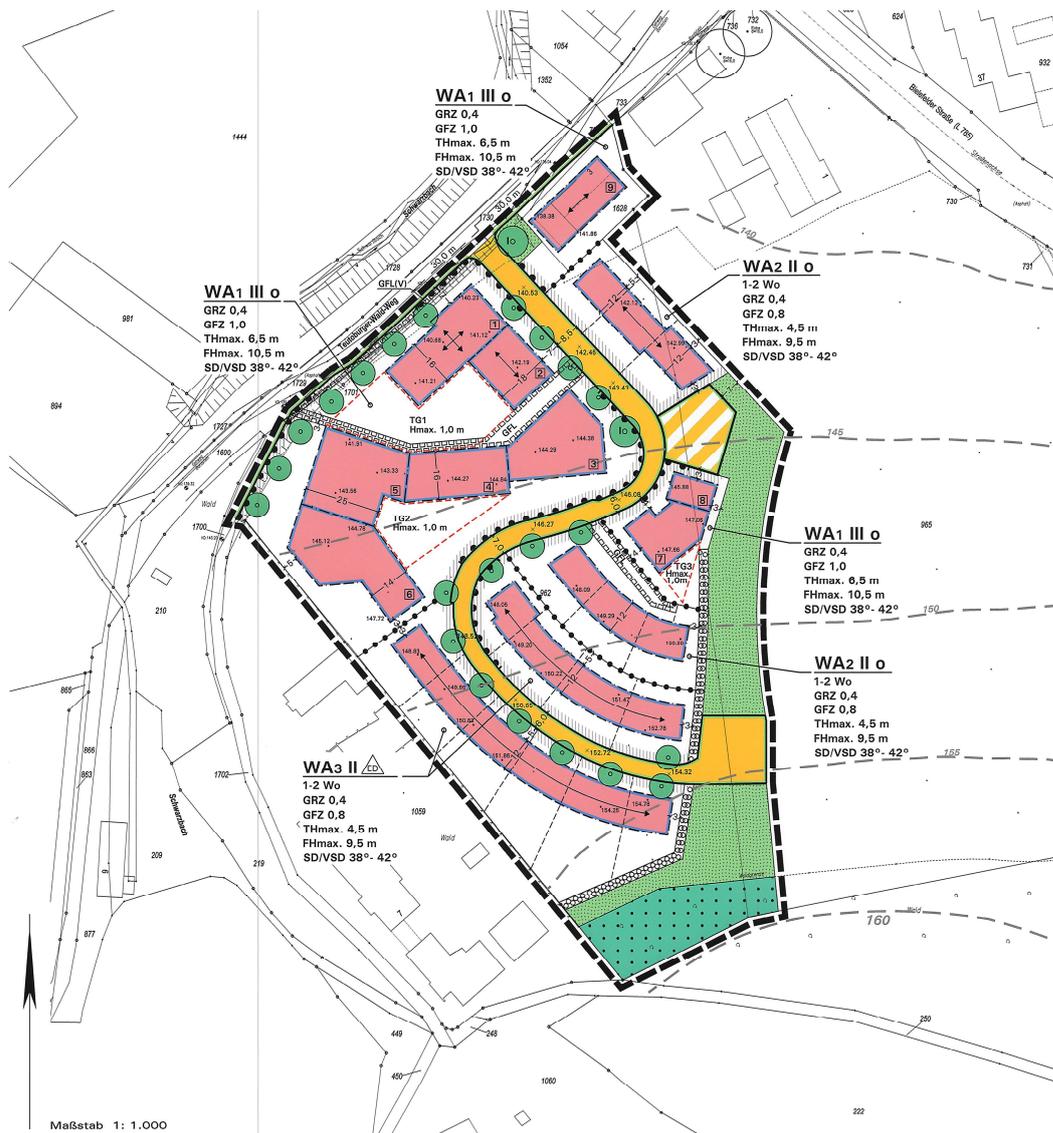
Bebauungsplan Nr. 43 – 1. Bauabschnitt [6]
